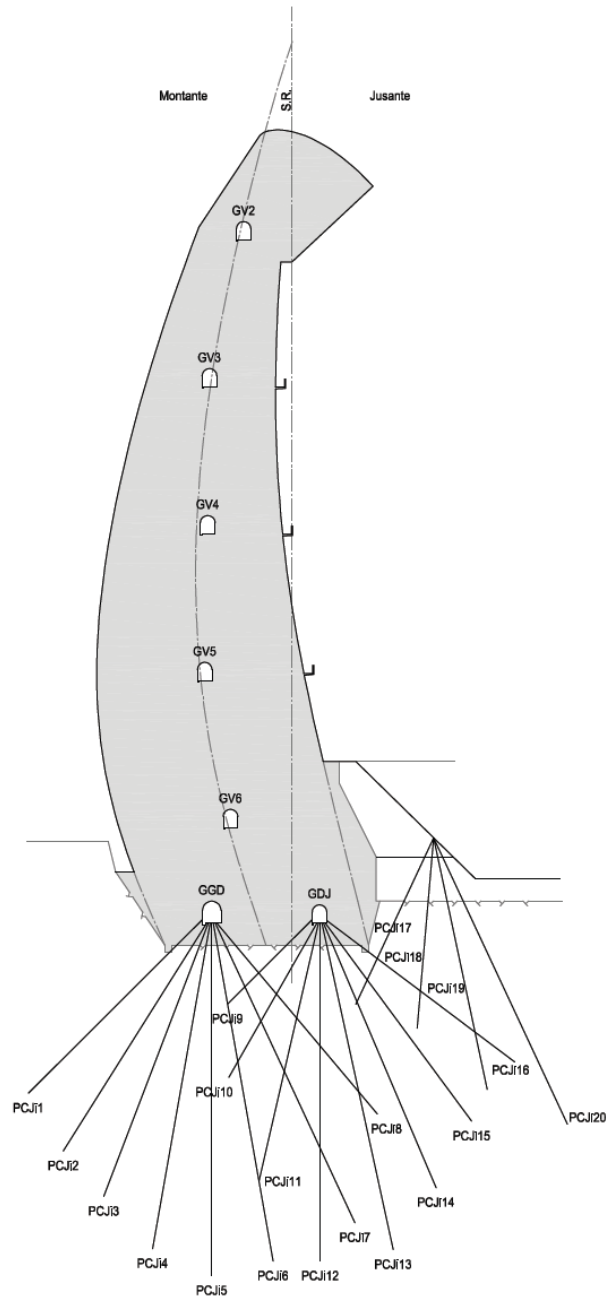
Pormenor tipo de um perfil fictício do fundo do vale de furação de consolidação
